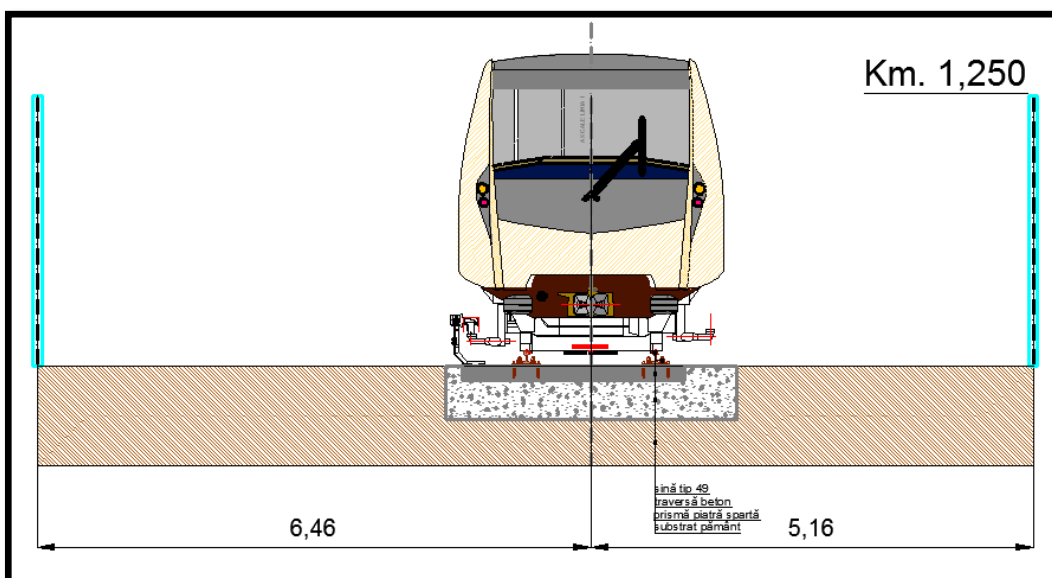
c.4.1.b - Situația existentă la cale de rulare - schiță
